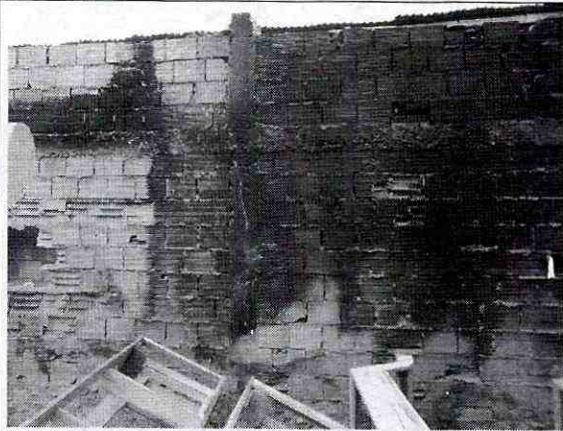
Deterioro en unidades de mampostería de los muros de la zona posterior
